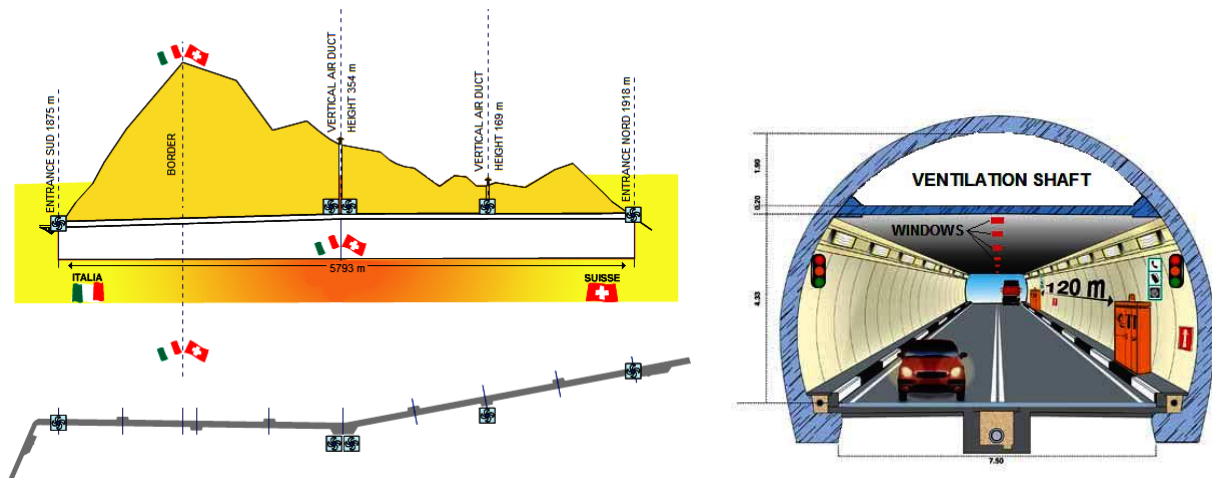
Sezione longitudinale e verticale del traforo del San Bernardo
